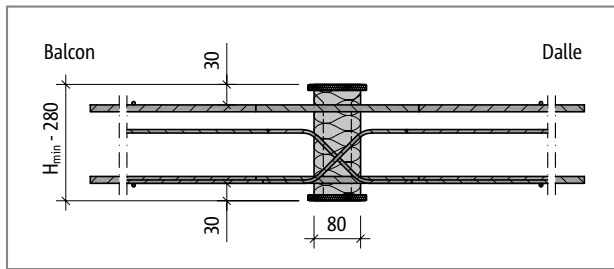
Schöck Isokorb® T Type D pour CV30 : Coupe du produit
